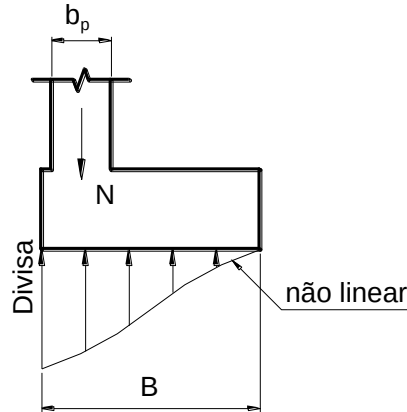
Sapata excêntrica sob pilar de divisa.
